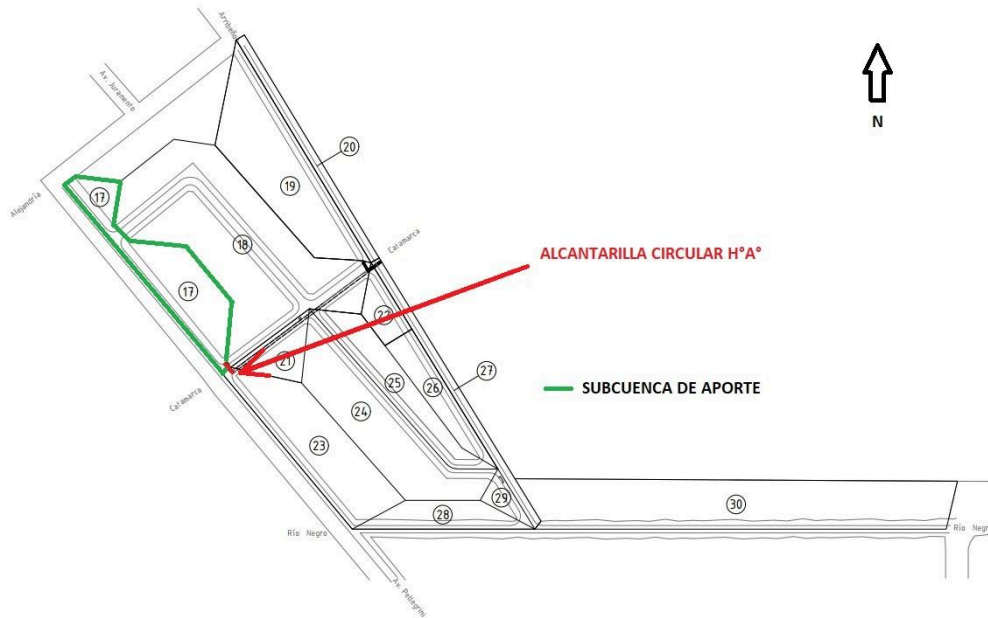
Ubicación de la alcantarilla a verificar + cuencas de aporte.
